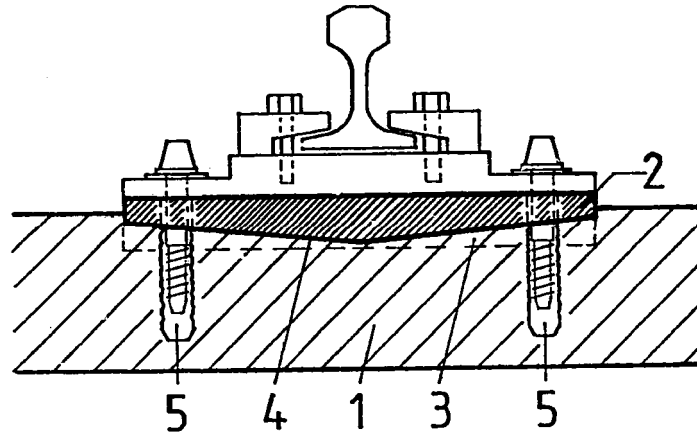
Querschnitt durch ein Stahlbetonfertigteile aus DE 24 22 942 C2
